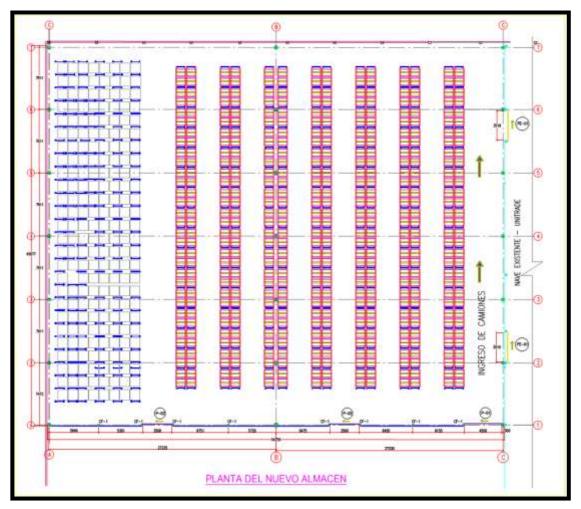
Plano de la Planta del Nuevo Almacén (Fuente: Propia)
